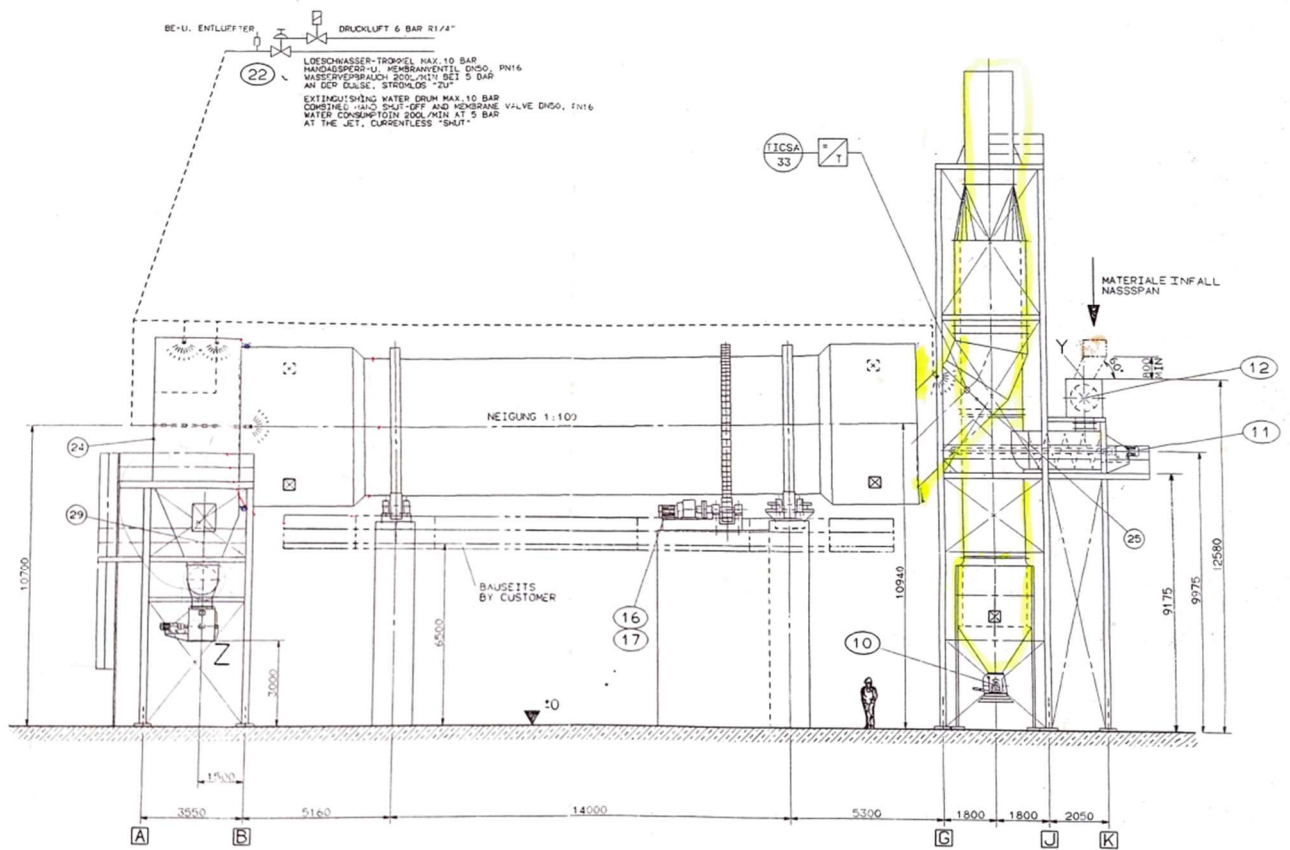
Disegno tecnico dell'impianto di essiccazione, prospetto ovest.
